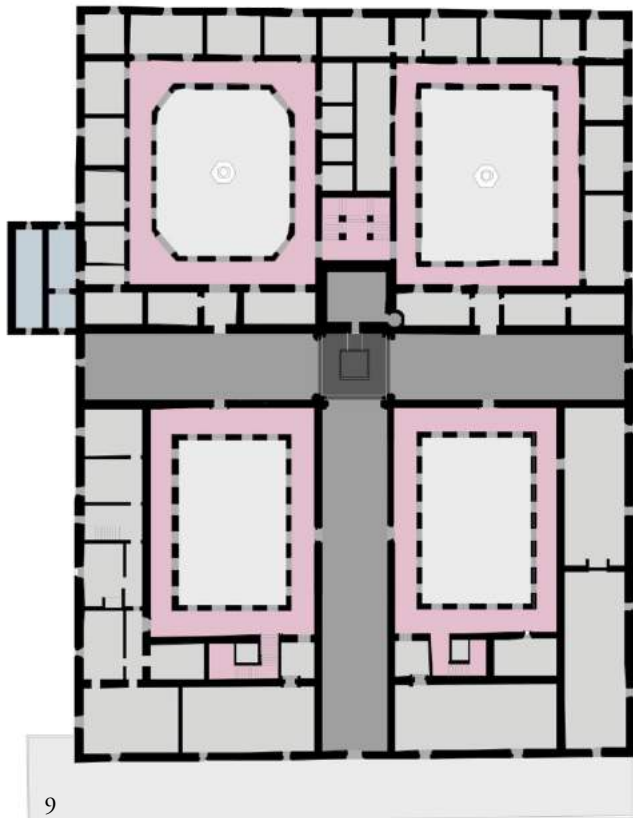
Hospital de los Reyes de Santiago. Hipótesis del estado constructivo a finales del siglo XVI (planta baja)
